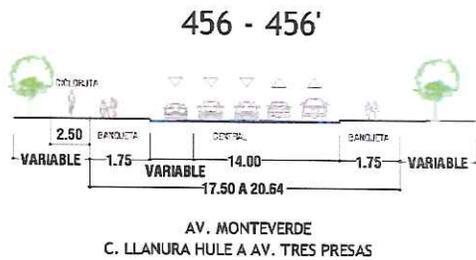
Sección vial existente Av. Monteverde. <sup>75</sup>
